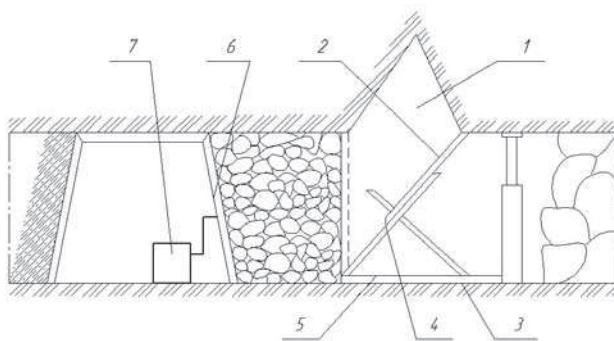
Охрана выработки с помощью твердеющей полосы (1 — место отбойки пород кровли, 2 — наклонный полок, 3—5 — гидродомкраты, 6 — опалубка, 7 — насосная установка)
